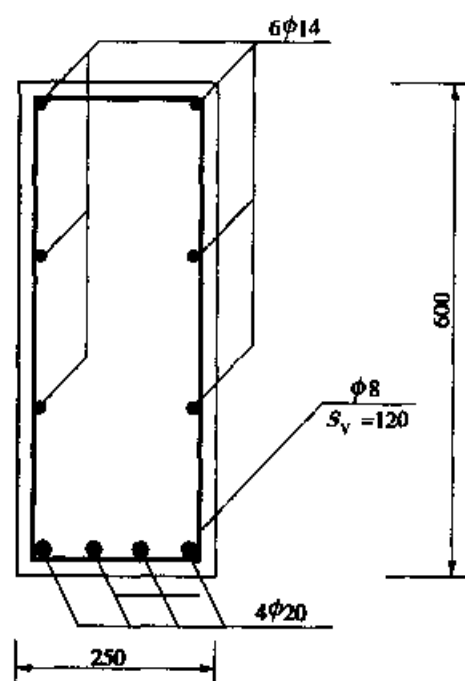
弯、扭构件配筋(尺寸单位:mm)
